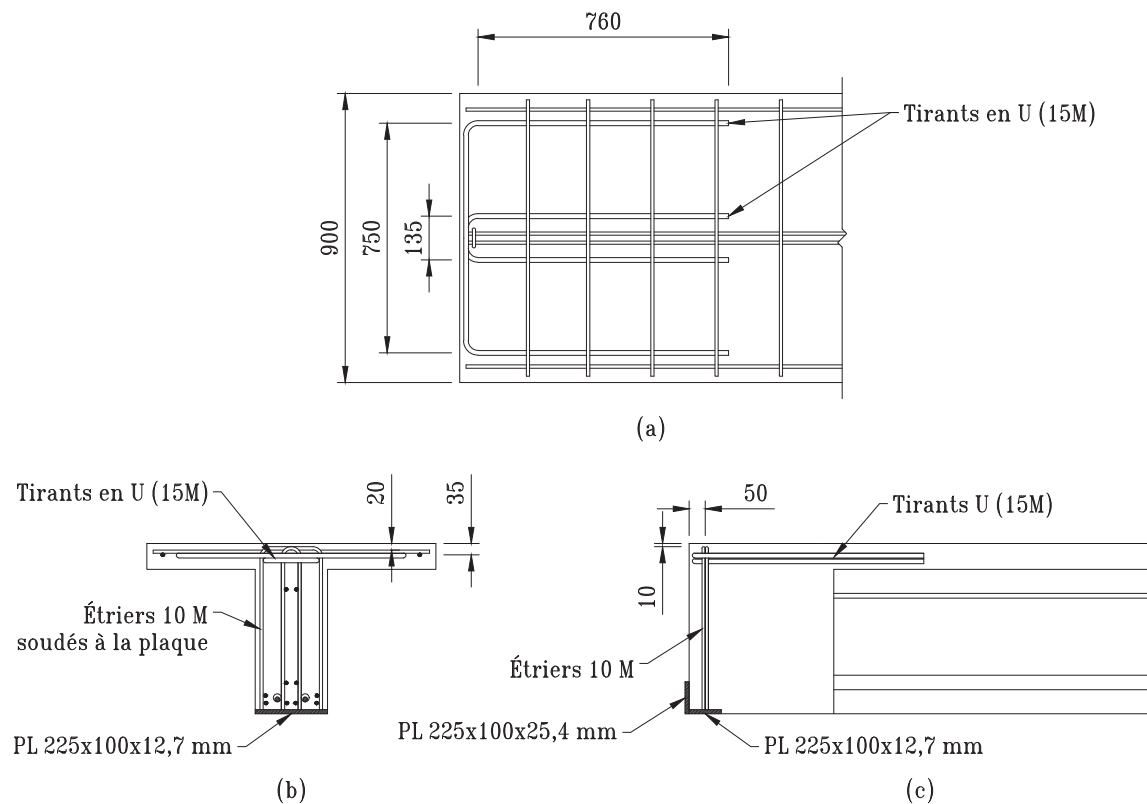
Armature aux extrémités de la poutre PBP-1 : (a) armature dans la dalle, (b) section et (c) vue en élévation
